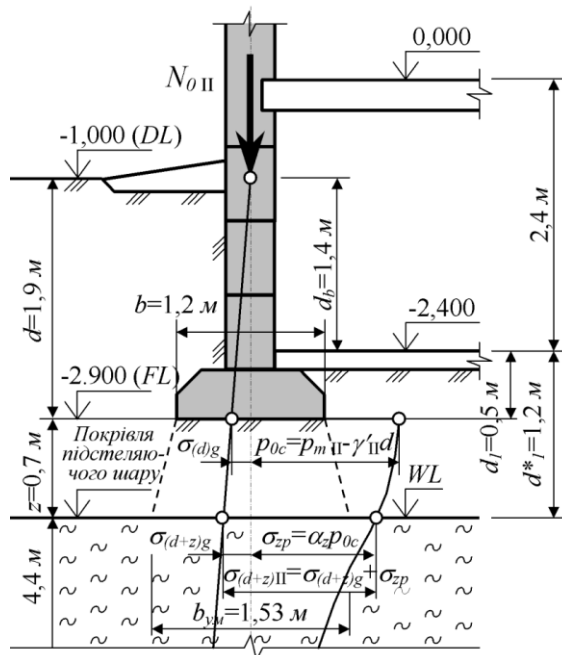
Інженерно-геологічний розріз, поперечний контур проектованого фундаменту, розрахункова схема до перевірки міцності слабого ґрунту підстеляючого шару основи
